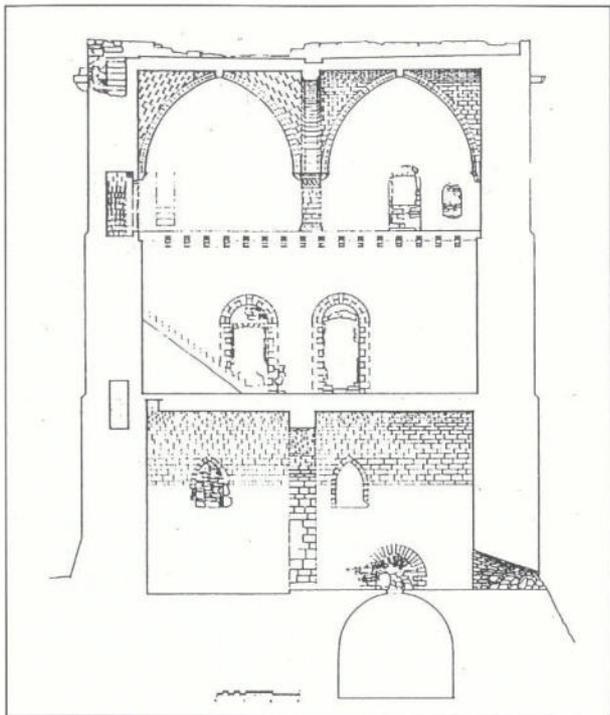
Sezione longitudinale (da SPATRISANO).
